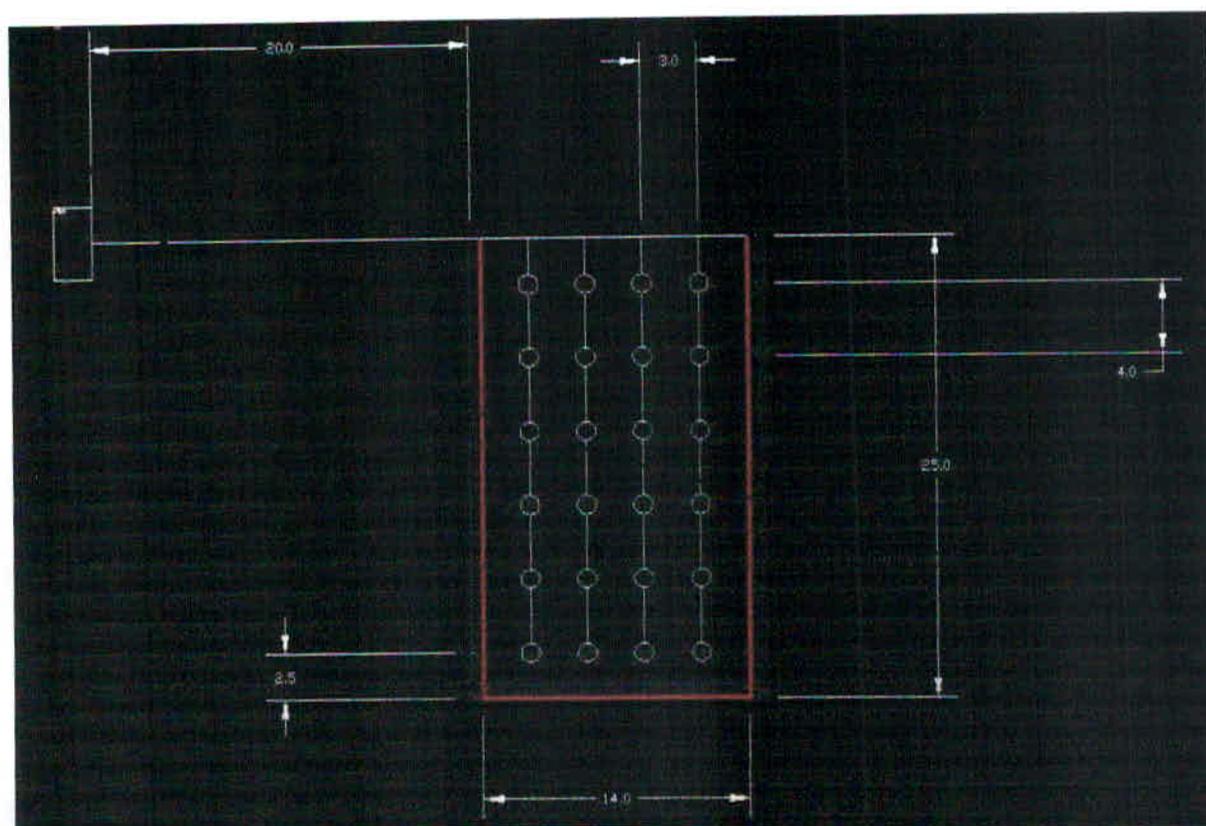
Layout do sistema de tubulação a ser dimensionada
